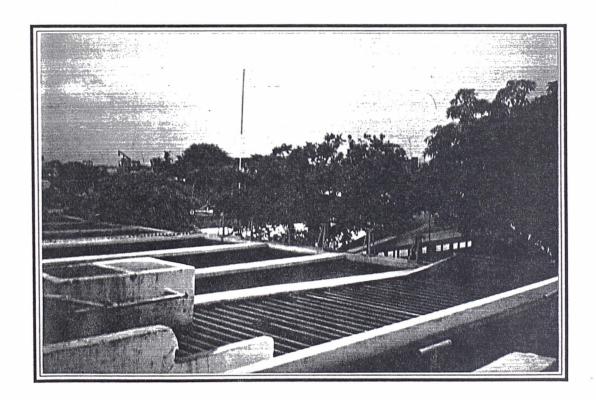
Floculador de la Planta Antigua con evidentes muestras de deterioro en las pantallas.
